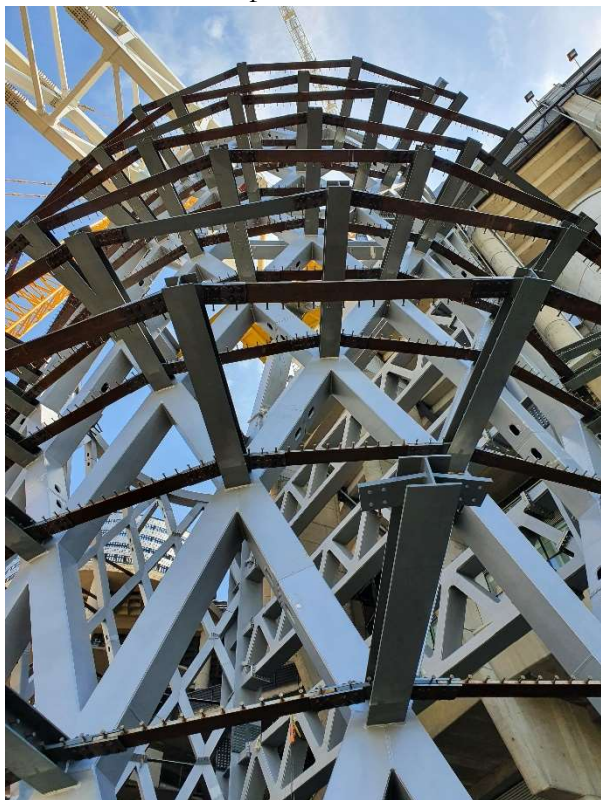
Estructura metálica de la Torre C para el apoyo de la cercha atirantada norte de la cubierta.
